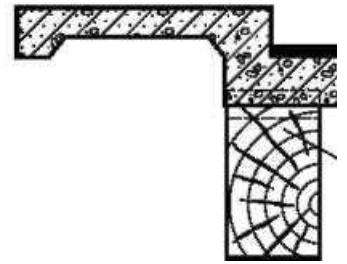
Конструкція деревозалізобетонної балочної пролітної будови:
